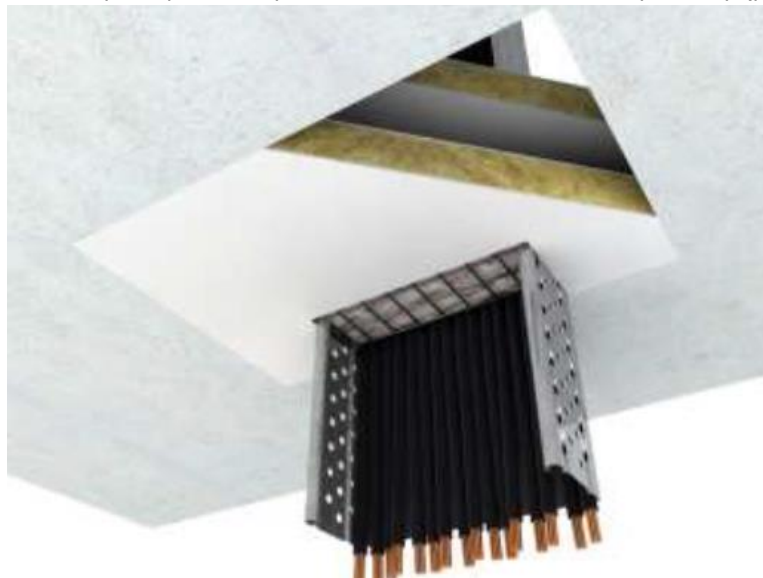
Модель монтажа проходов на основе подушек DB в перекрытиях
